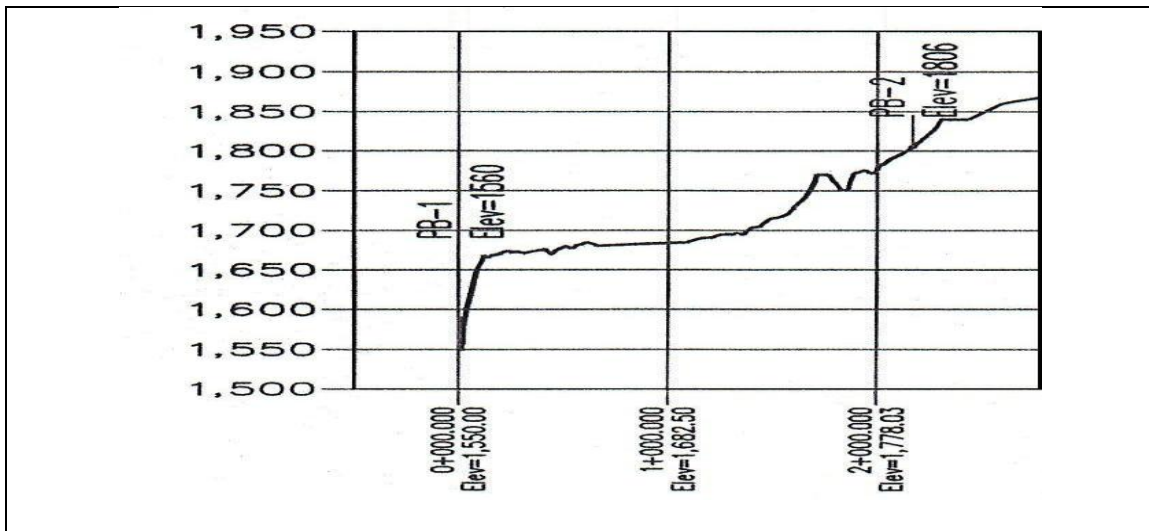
, Perfil de elevaciones del acueducto entre las plantas PB1 y PB2
